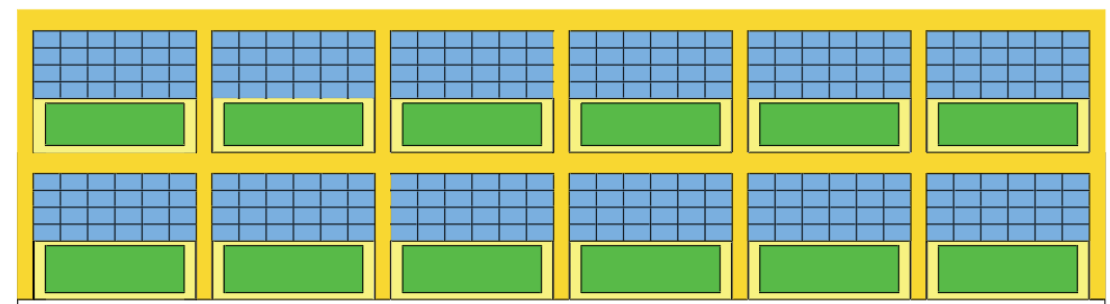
Elevación posterior del pabellón 8. Fuente: Elaboración propia.
